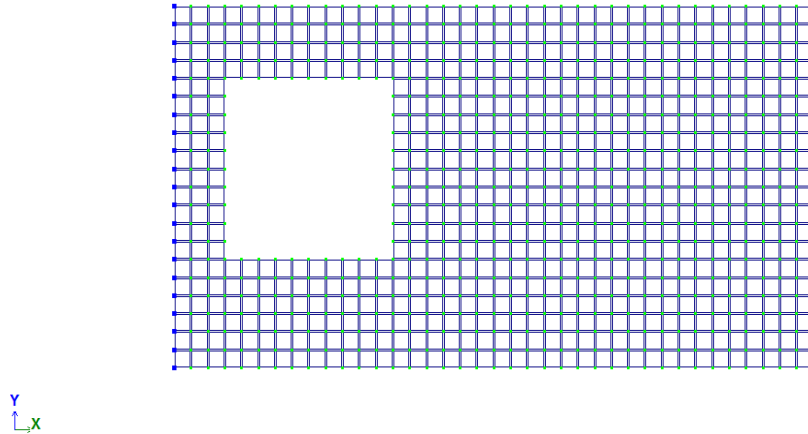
Расчетная схема монолитной плиты перекрытия
